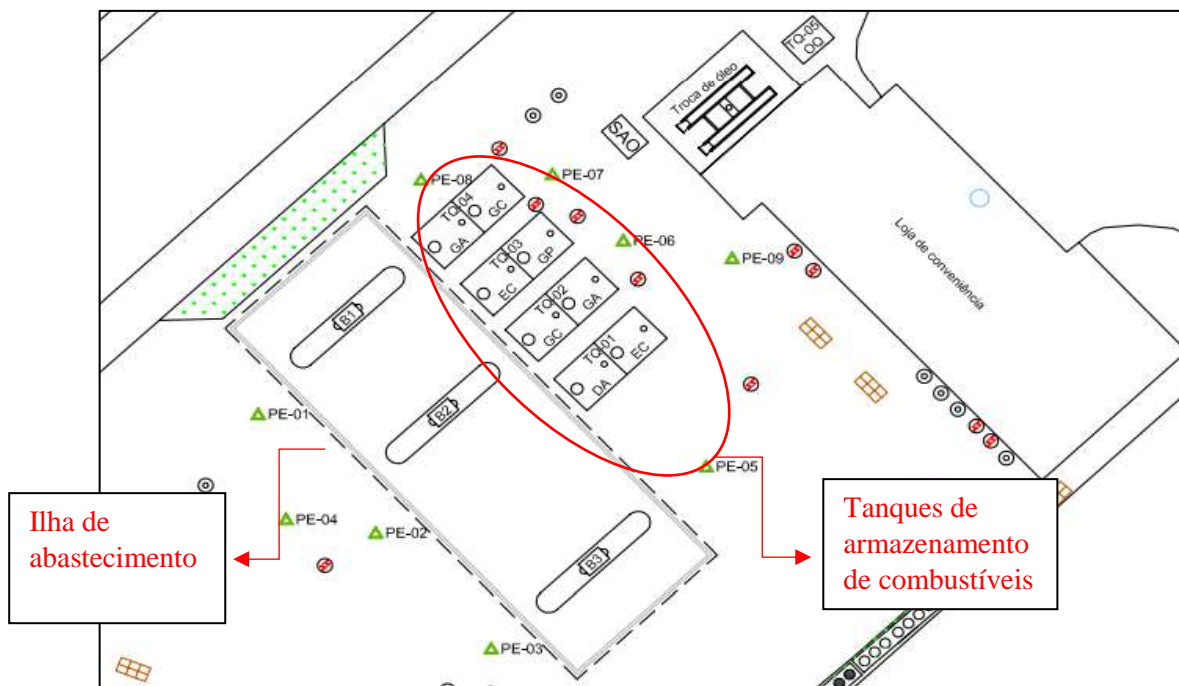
Recorte adaptado da planta baixa do PRC em estudo.
